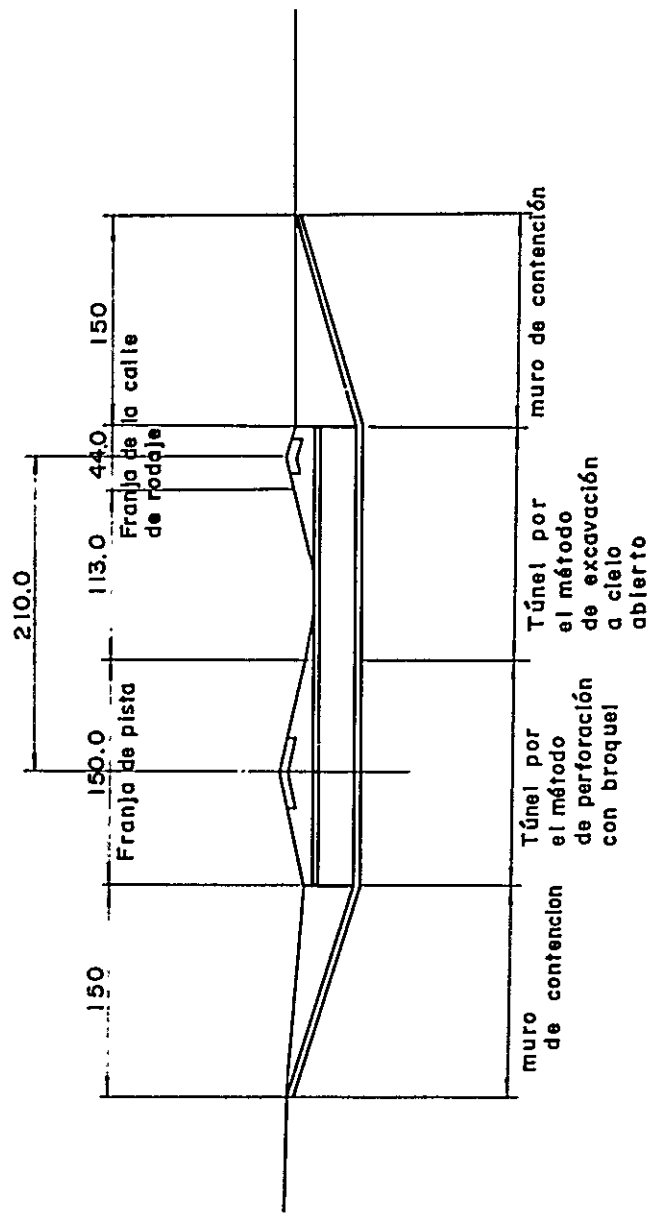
Sección Longitudinal del Túnel por debajo de la Pista
